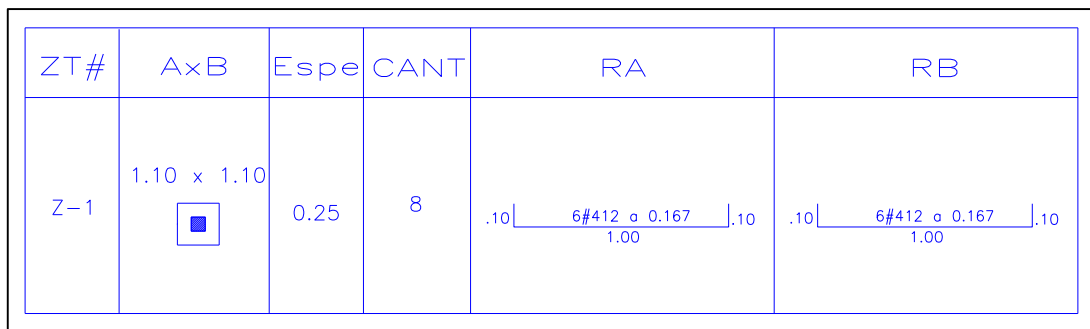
Despiece acero de refuerzo de zapatas.
